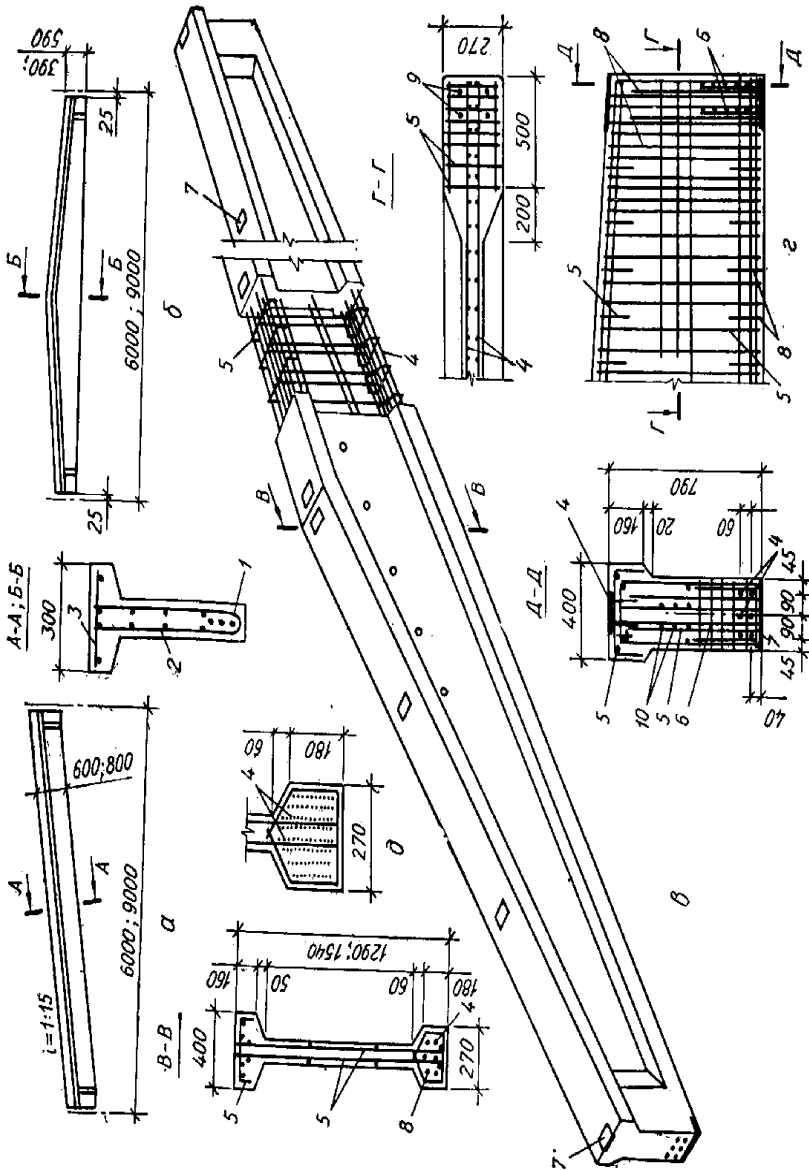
Балки покриттів: а – односхила; б, в – двохсхилі балки; 2 – армування опорного вузла; 2 – варіант армування дротом Вр-І; 1 – пакет арматурних стержнів; 2 – гнута зварна сітка; 3 – каркас поліції; 4 – попередньо напружена арматура; 5 – зварний каркас; 6 – зварні сітки на опори; 7 – закладна деталь; 8 – хомути; 9 – анкери стержні деталі; 10 – окремі стержні
